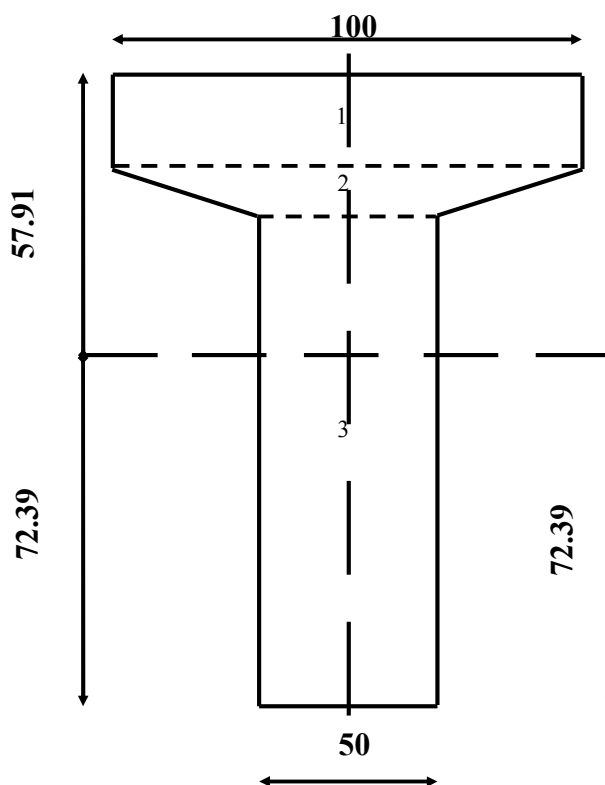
Dimension de la poutre d'about sans dalle.
